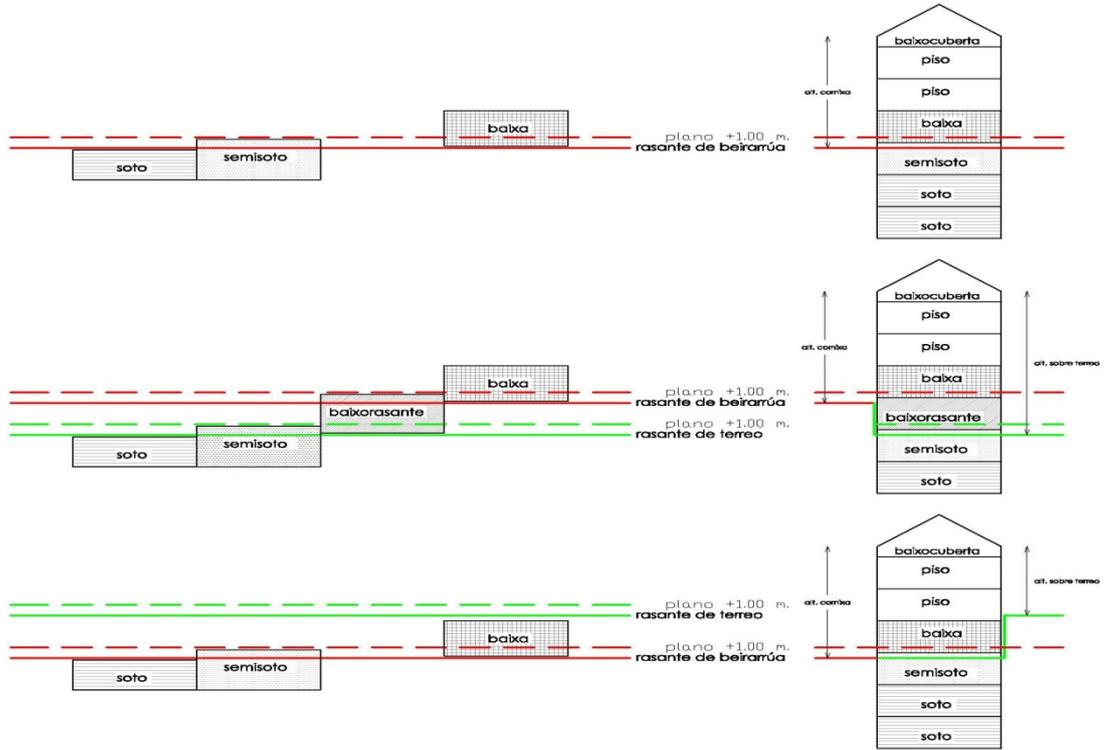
Posición de plantas sótano, semisoto, baixorasante y baja con respecto a rasante de acera y la rasante del terreno
